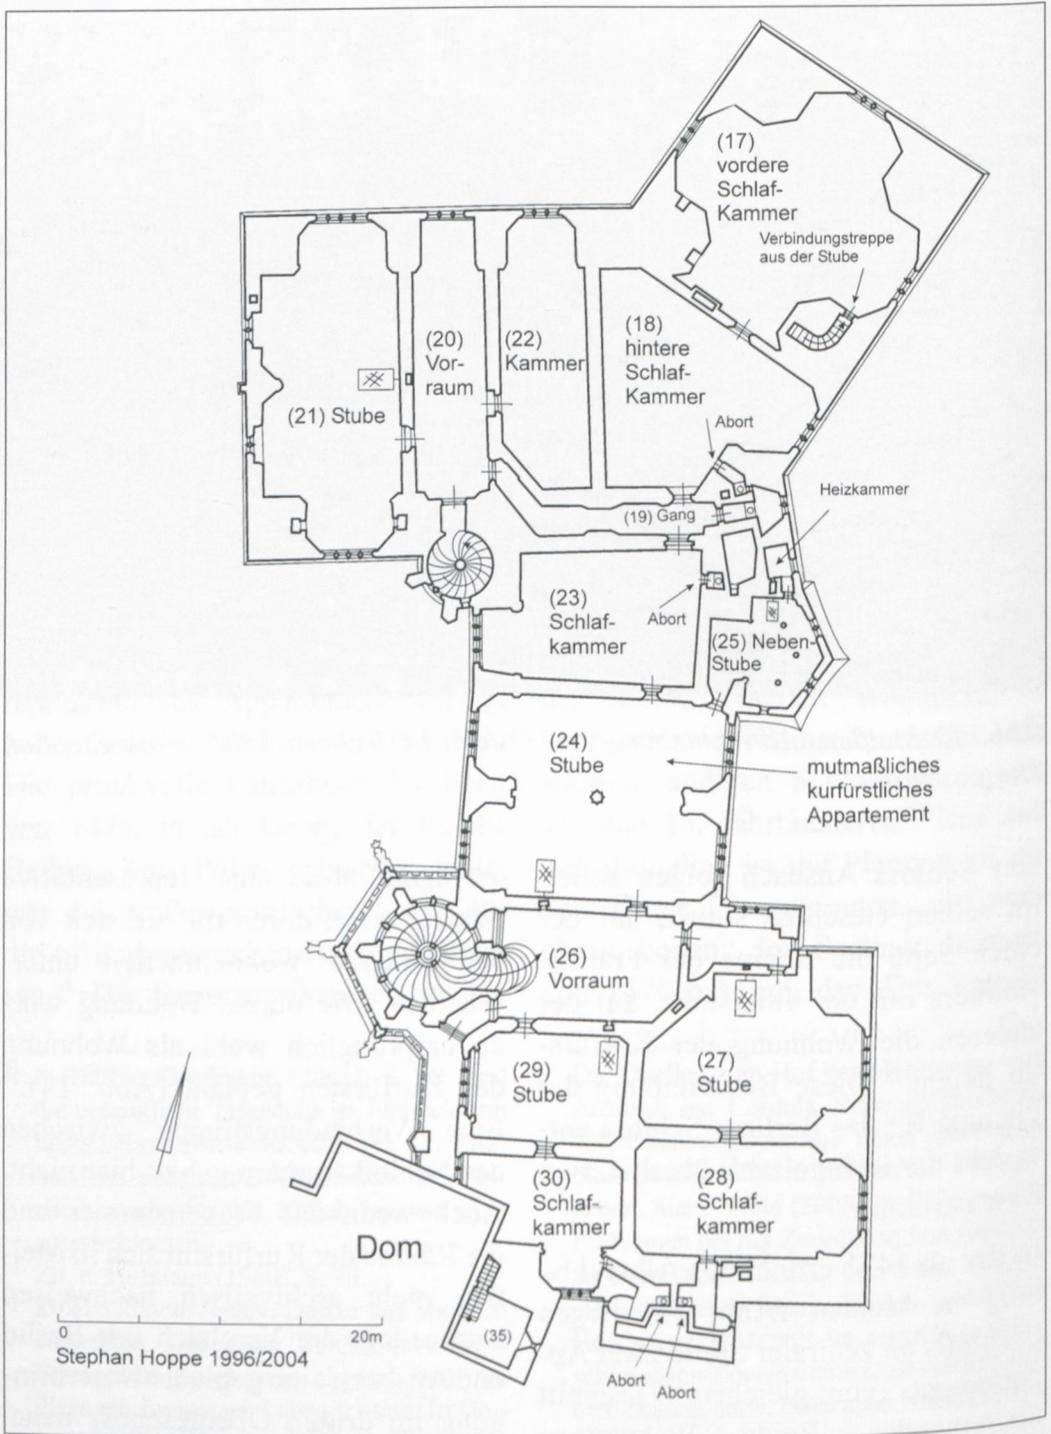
Meissen, Albrechtsburg, Grundriss zweites Obergeschoss mit Rekonstruktion der funktionalen Raumstruktur, Stephan Hoppe 1996/2004
